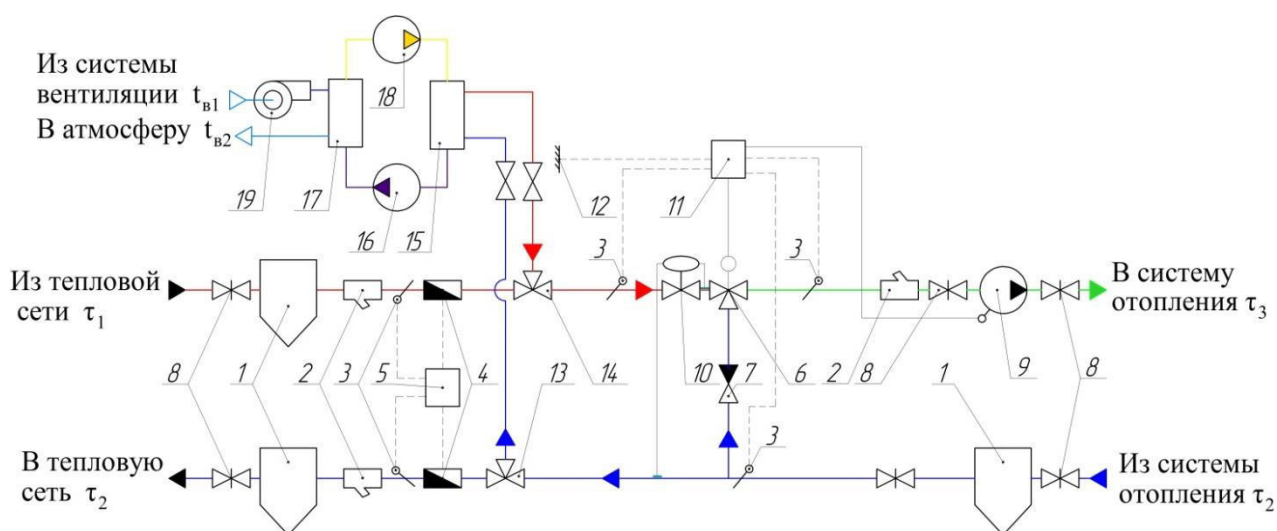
Принципиальная схема автоматического теплового узла здания с тепловым насосом, работающим на вентиляционных выбросах:
